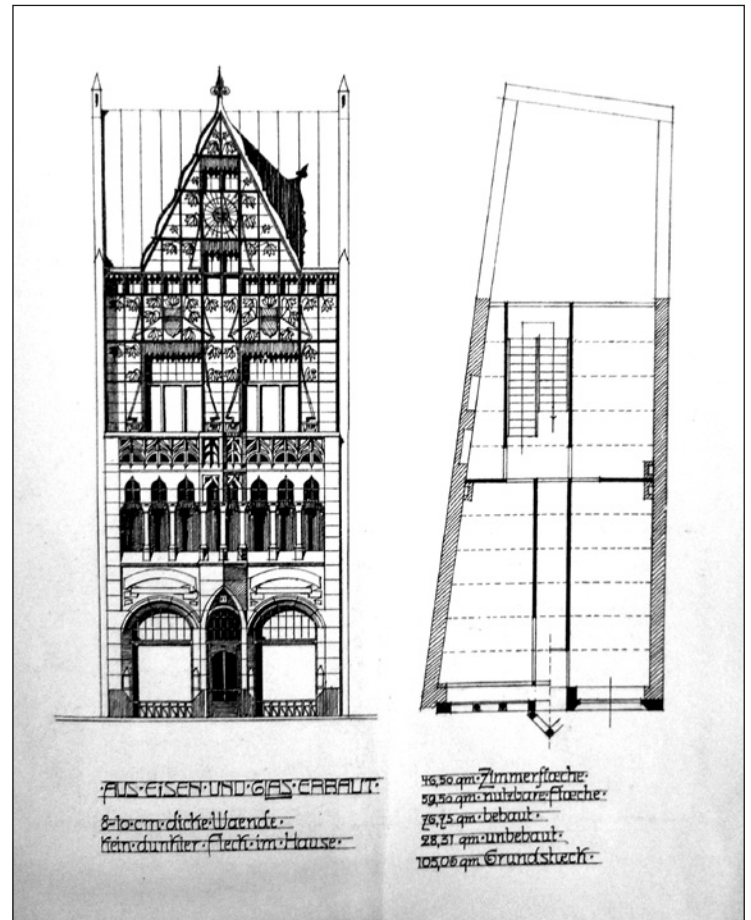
St.-Anton-Straße 91, Krefeld, 1899 von Buschhüter errichtet, Ansicht der Fassade und Grundriss
